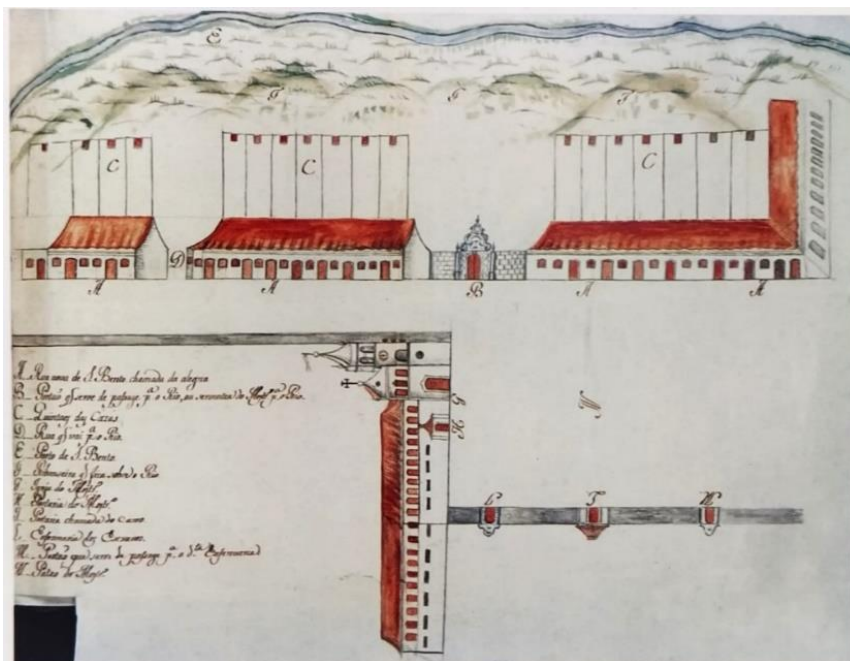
Antiga planta do Mosteiro de São Bento de São Paulo
